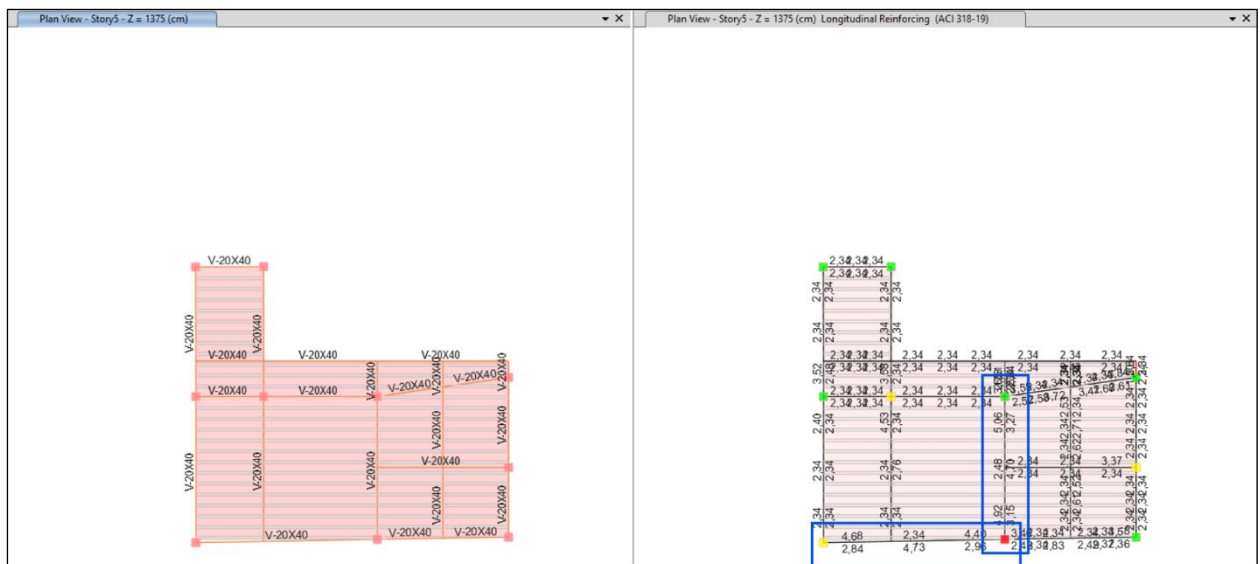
Acero a flexion en vigas de losa nivel 5, alternativa 1 [Autor]
